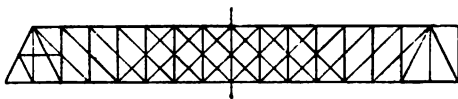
Poutre Linville. — Voie inférieure et voie supérieure.
